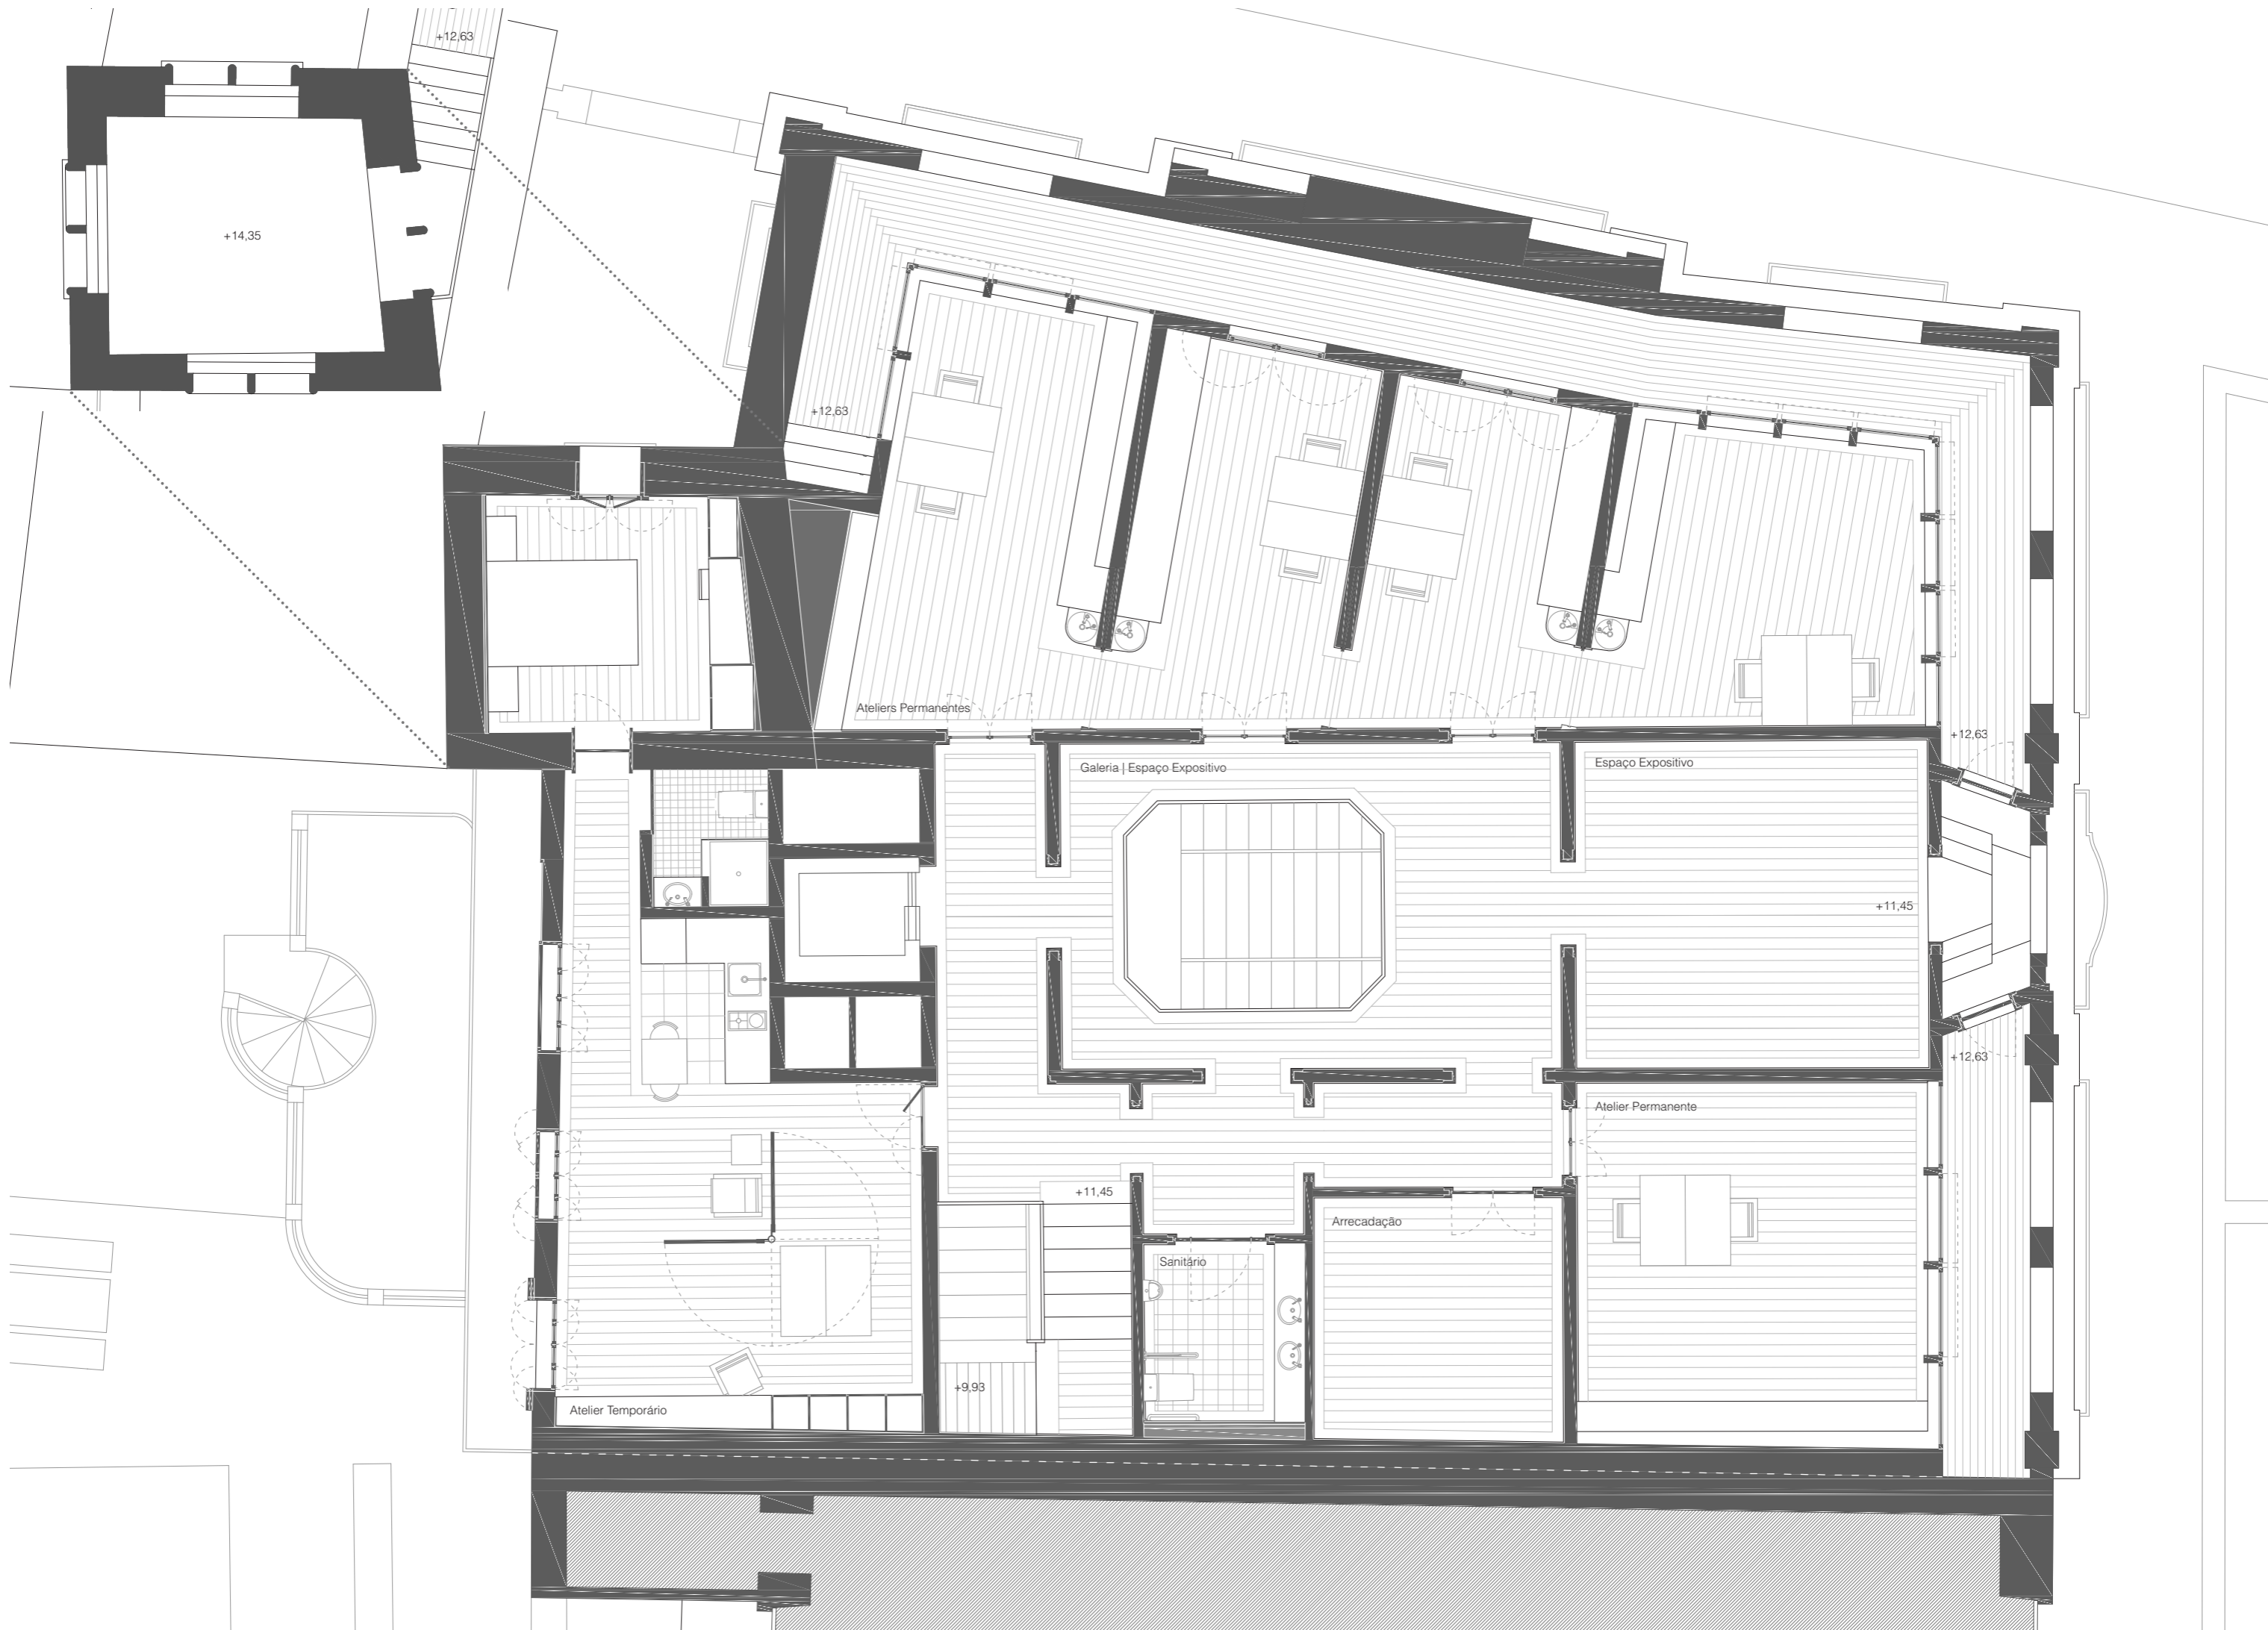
Planta de demolições e novas construções - piso rés-do-chão - escala 1:200
